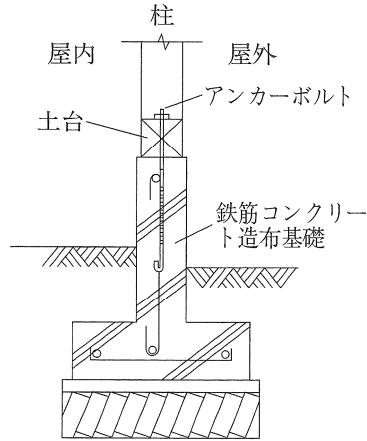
土台を鉄筋コンクリート造布基礎に緊結した例
